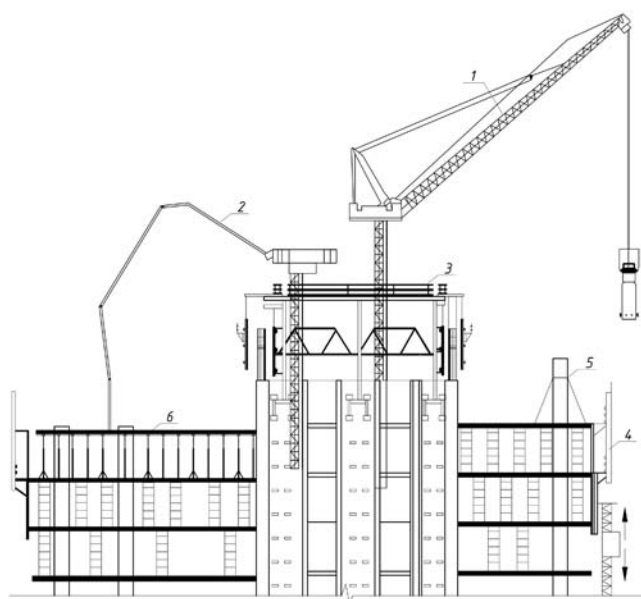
Технологическая схема производства работ: 1 – самоподъёмный башенный кран; 2 – распределительная стрела бетононасоса; 3 – самоподъёмная опалубка лестнично-лифтового узла; 4 – ветрозащитные щиты; 5 – оболочка колонны; 6 – монолитное перекрытие
